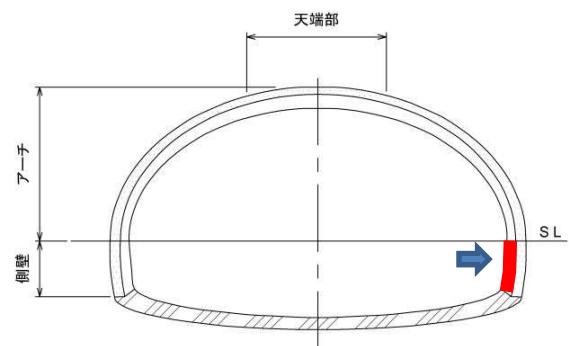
コールドジョイントに沿って発生したひび割れ
